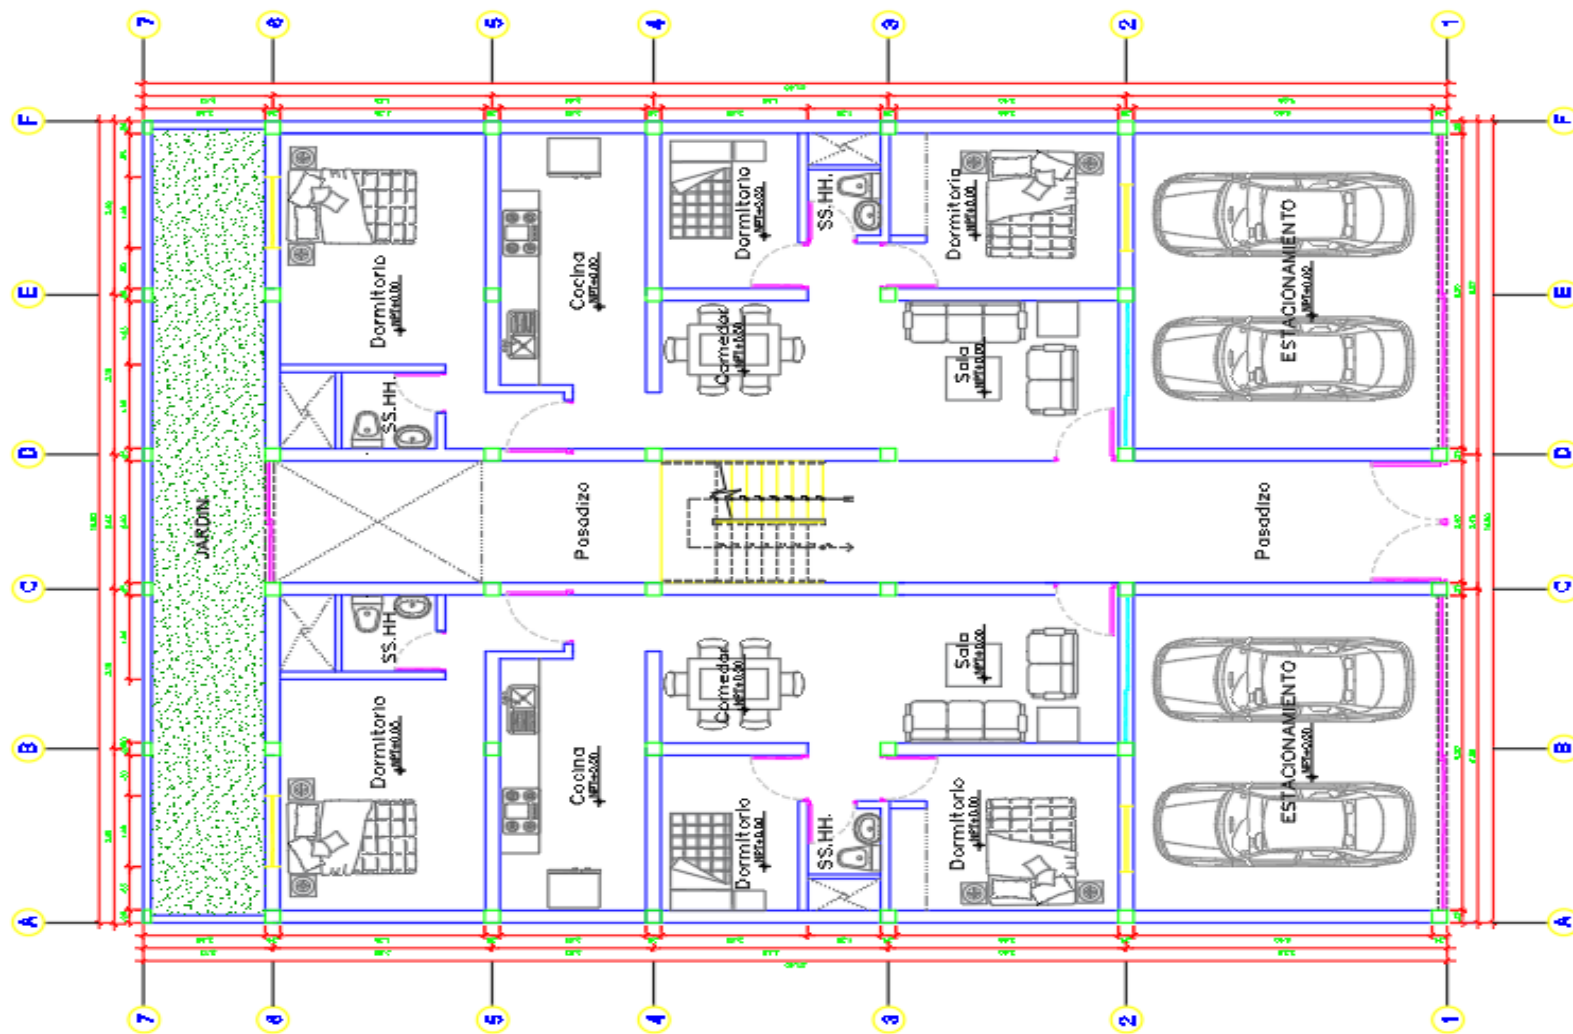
Plano de distribución del 1er Nivel – Albañilería armada Placa P-14
